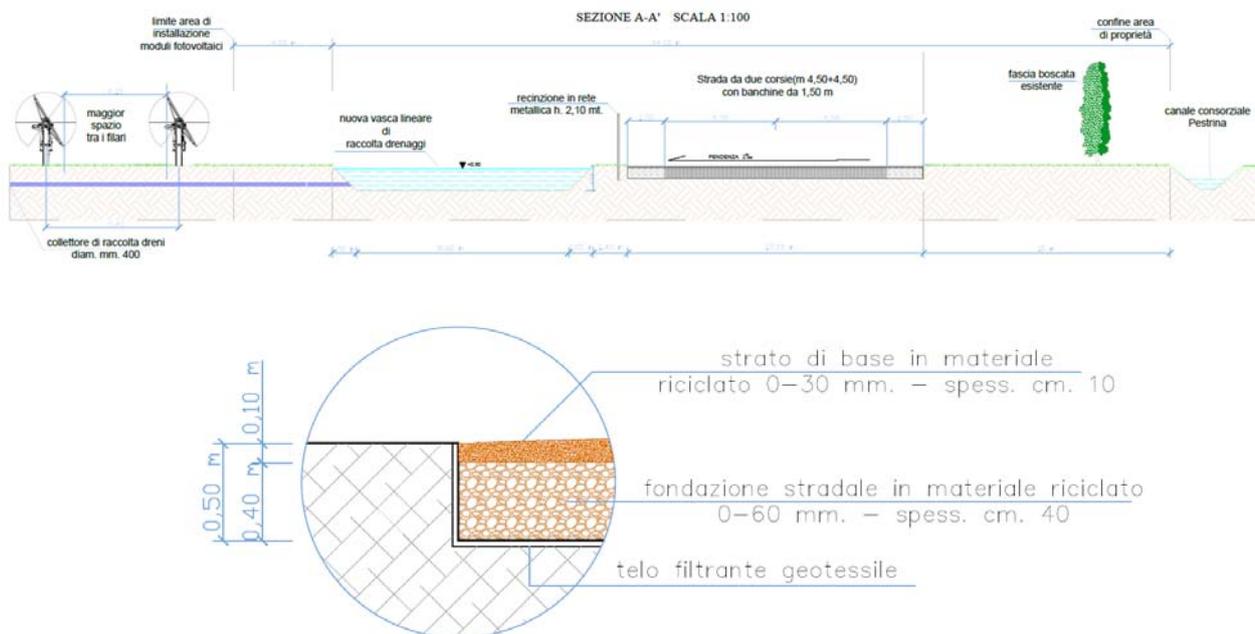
Sezione e particolare della strada perimetriale esterna in massicciata sul perimetro est dell'impianto
